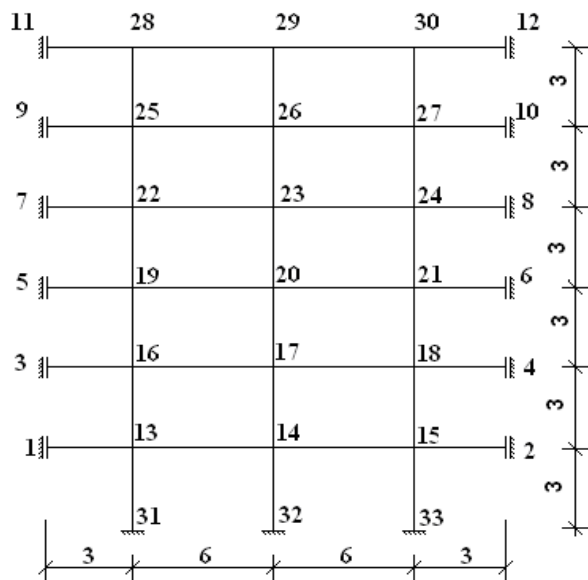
Фрагмент пространственного каркаса в виде двухпролетной шестиэтажной рамы.
